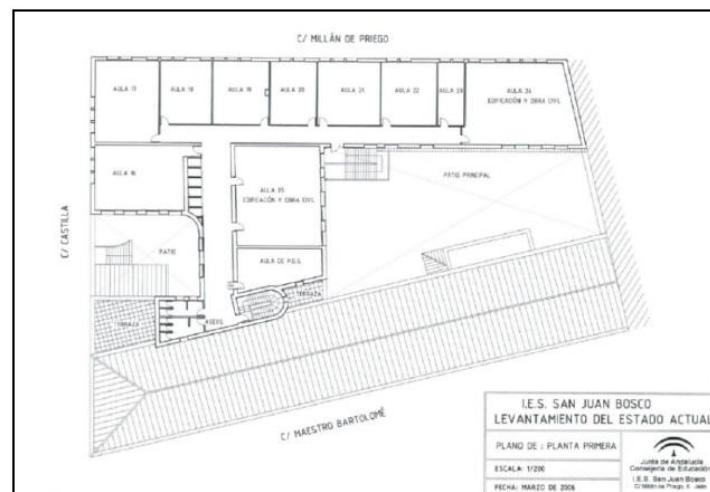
Plano del instituto de la Planta primera. Fuente: Plan de centro I.E.S. San Juan Bosco.
